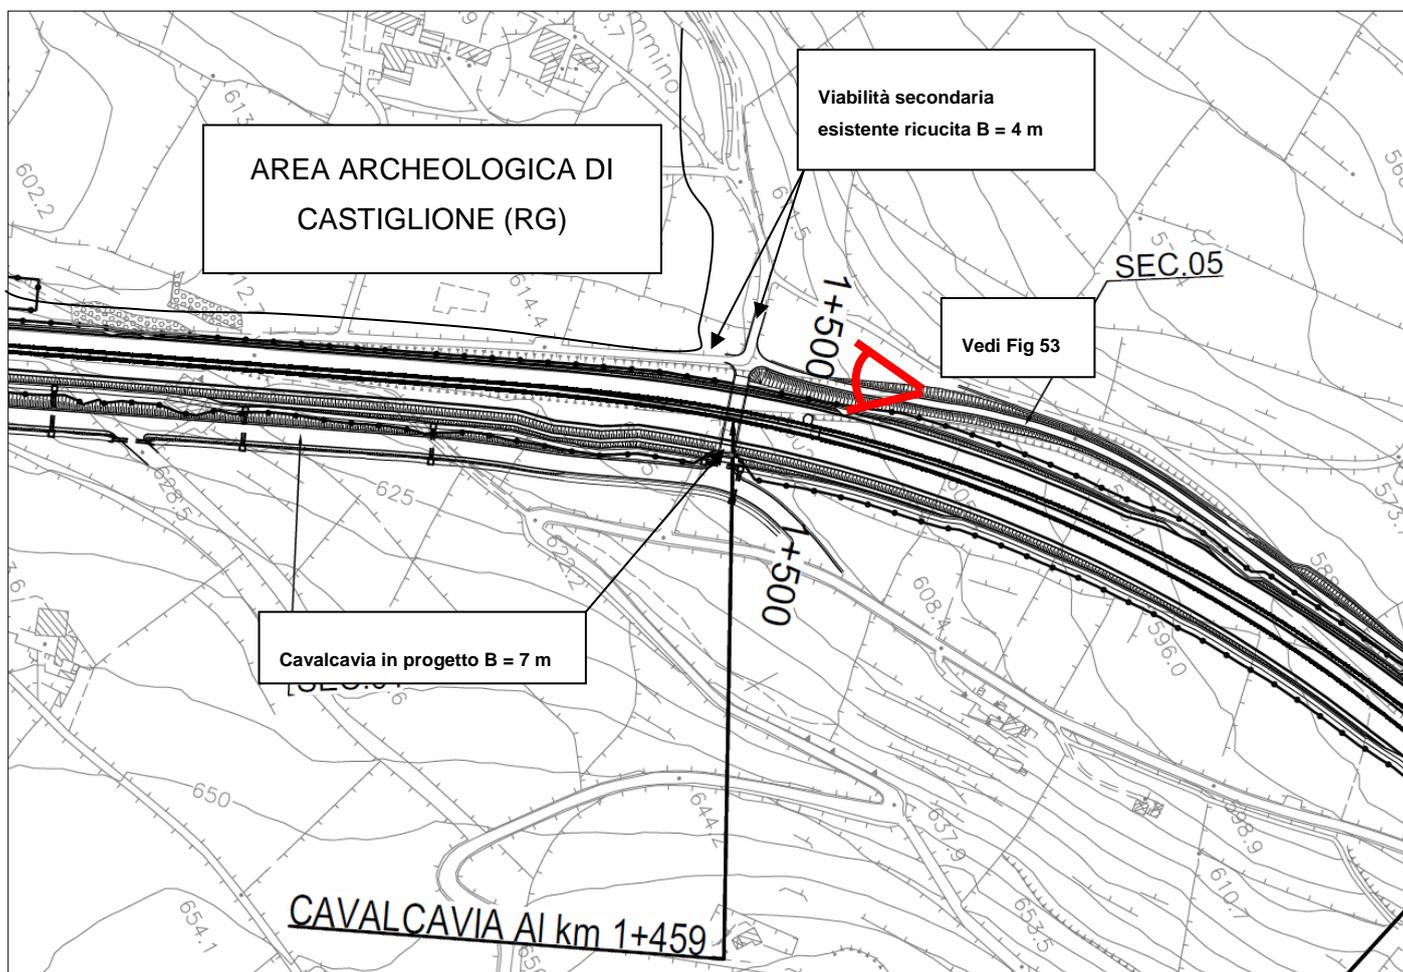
Stralcio planimetria di progetto in corrispondenza dell'area archeologica
